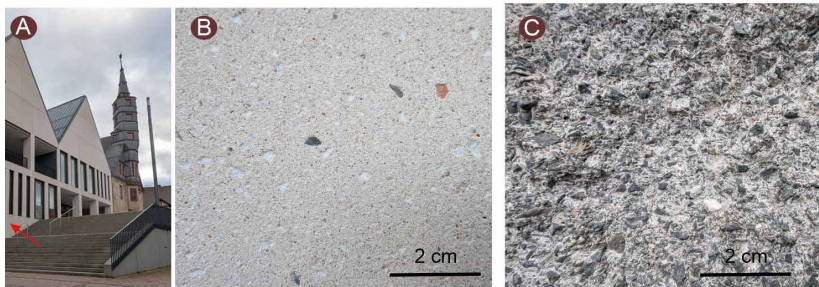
Betonzyklat (Material des Vorgängerbaus wurde wiederverwendet.)
